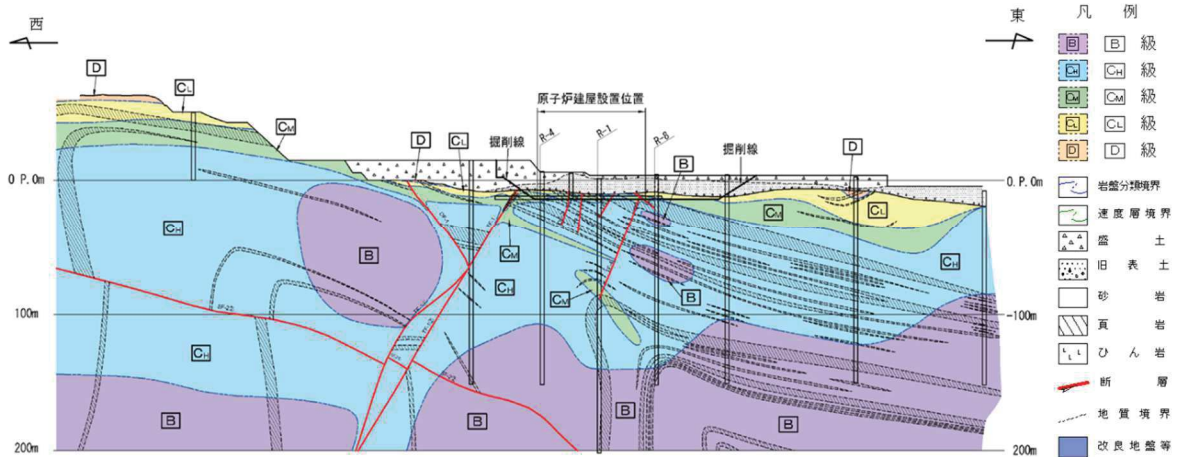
(1) 原子炉建屋の地質断面図 (①-①断面)
